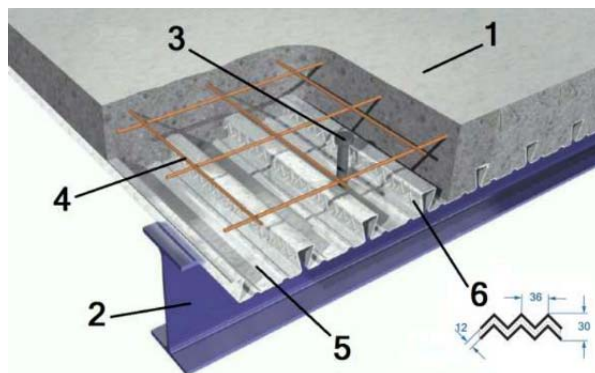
Конструкція ефективної монолітної залізобетонної плити перекриття з «замковим» профільованим настилом у якості незнімної опалубки та зовнішнього армування:
